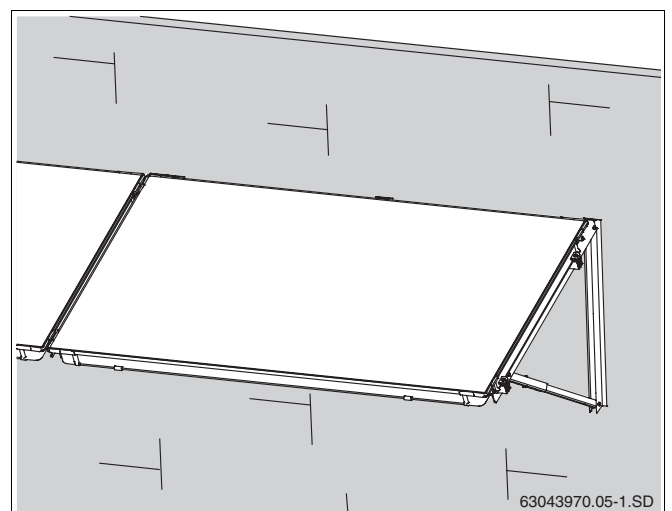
Imagem geral do conjunto de colectores, montagem na fachada
